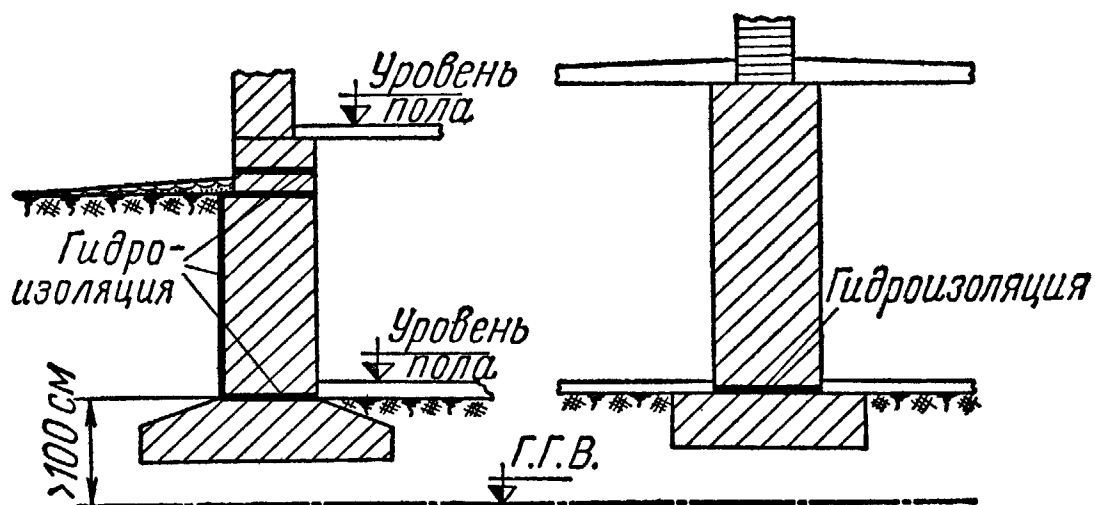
Расположение гидроизоляции в фундаментах при подвальных помещениях и при горизонте грунтовых вод ниже подошвы фундамента
